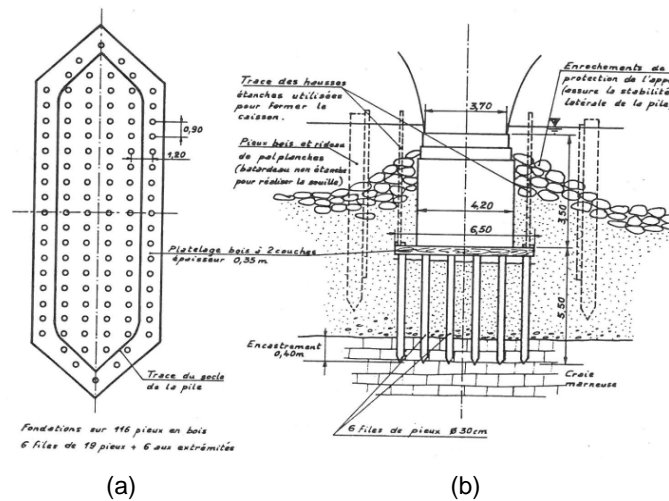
Fondations du pont de Saumur (Levillain, 1980)
